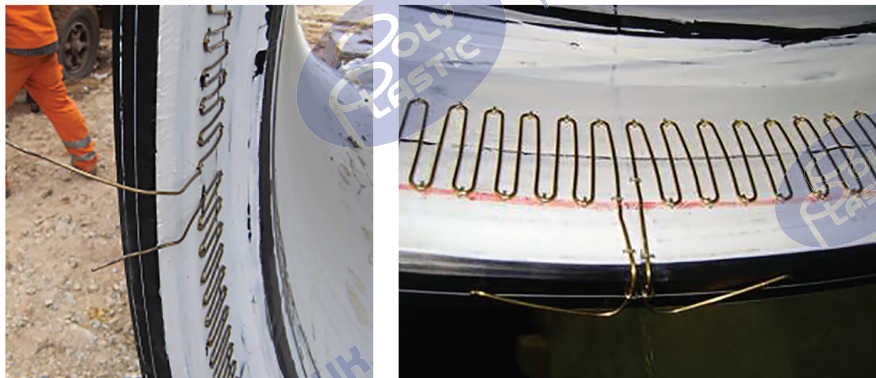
Выводы ЗН для подключения сварочного аппарата
